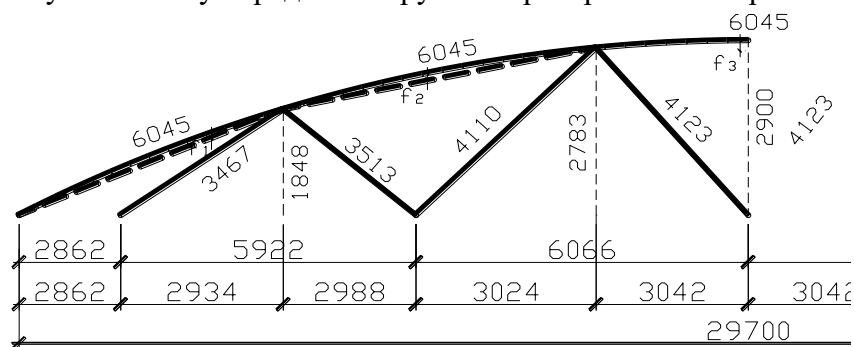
Геометрическая схема и схема передачи нагрузки на ферму.
